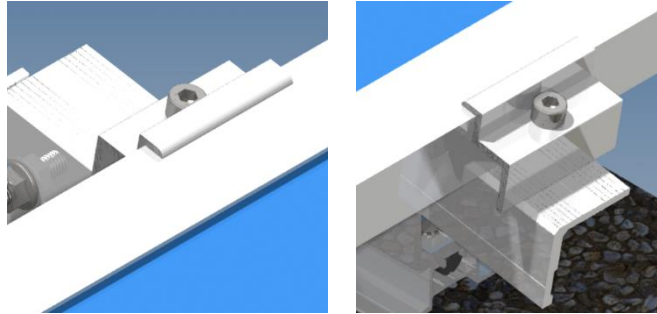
Detalle Brida Extremo para la fijación de las placas fotovoltaicas
